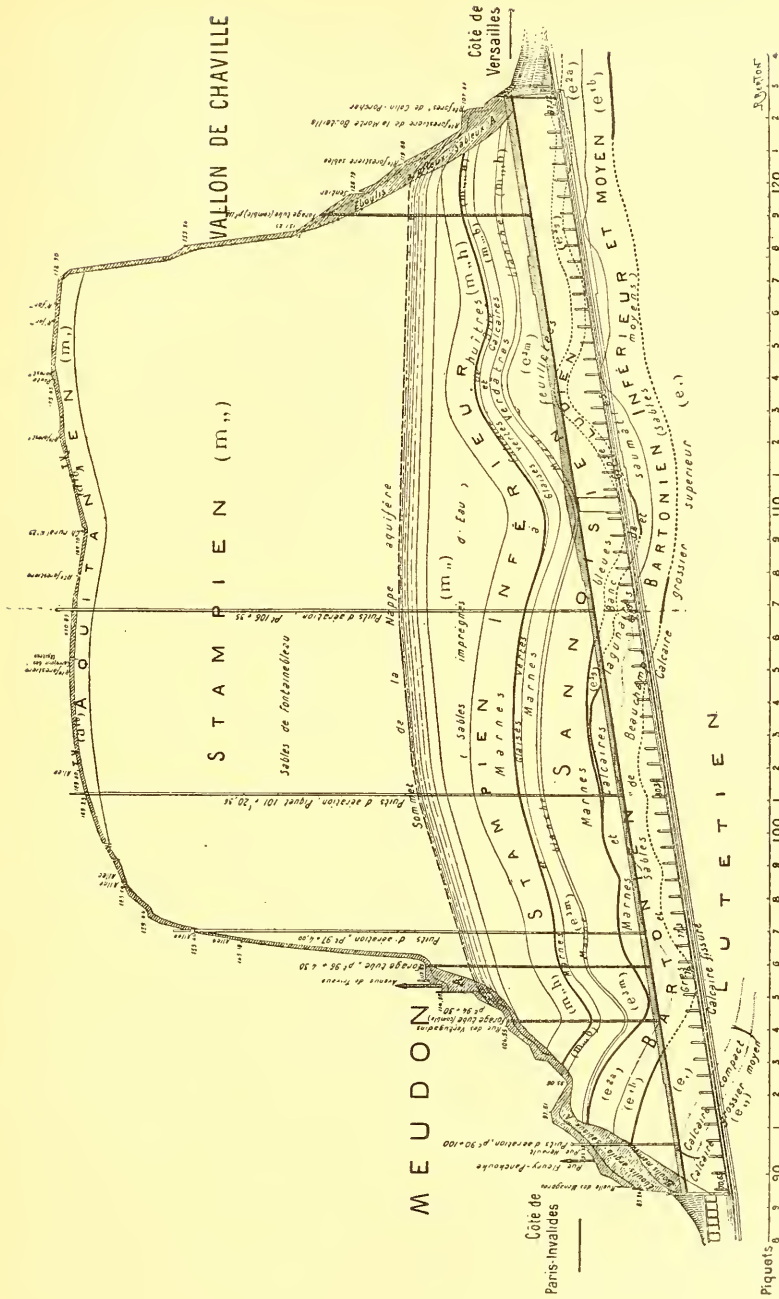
Coupe longitudinale du TUNNEL DE MEUDON par MM. Ramond et Dollo (hauteurs vingtplées).
